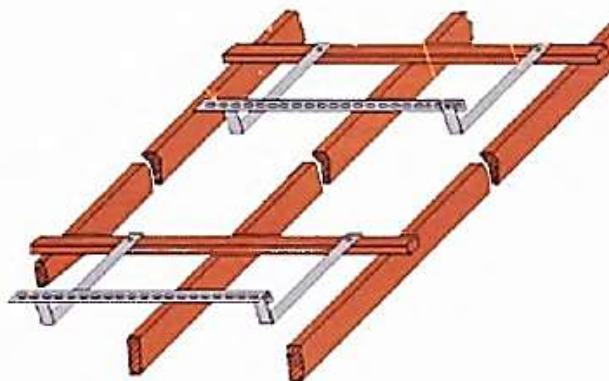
Монтажна схема кріплення рами до даху, вкритого черепицею
